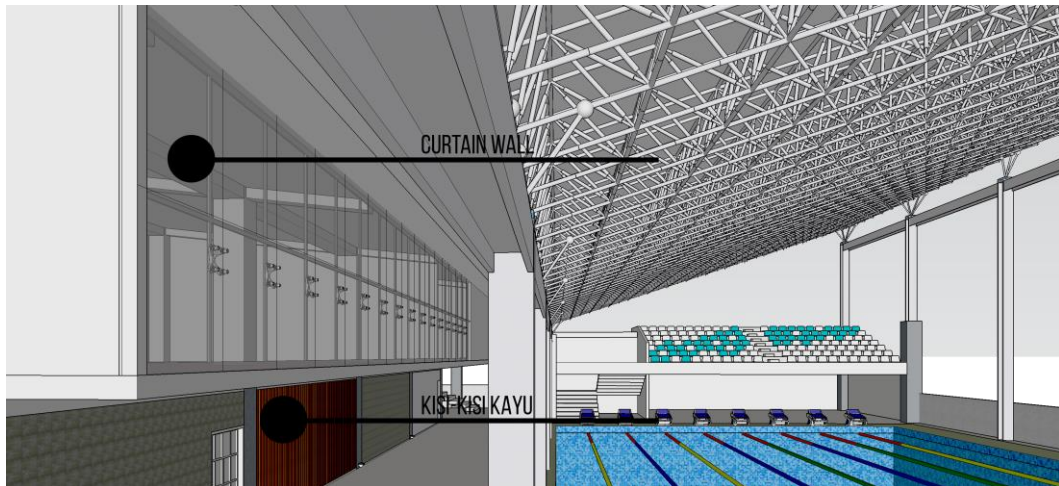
20 Selubung Bangunan Kantor Depok Sport Center
